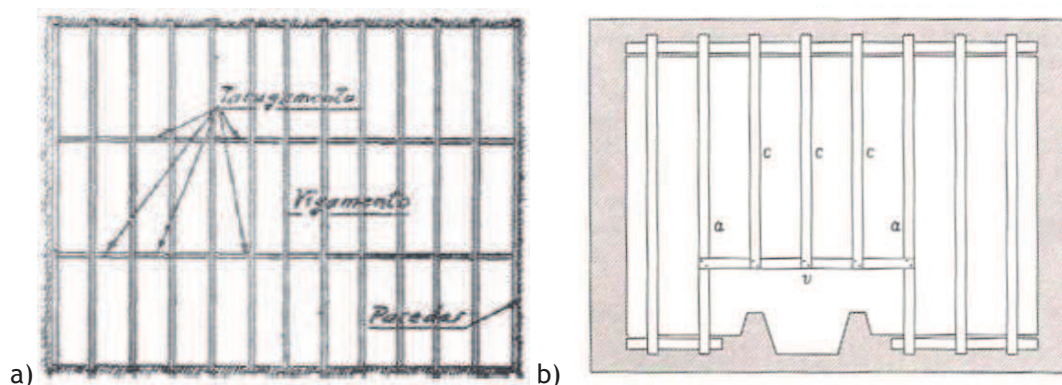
Exemplos de estruturas de madeira: a) estrutura de teto de esteira simples [Costa, 1955]; b) estrutura de pavimento com interrupção para chaminé [Leitão, 1896].
